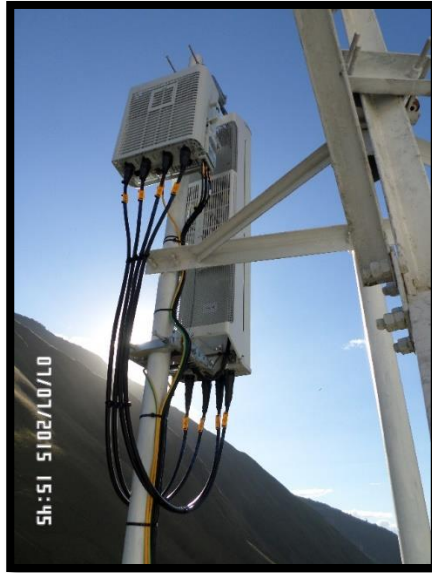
Cableado completo de la Antena a la RRU, Site Santa Teresa
